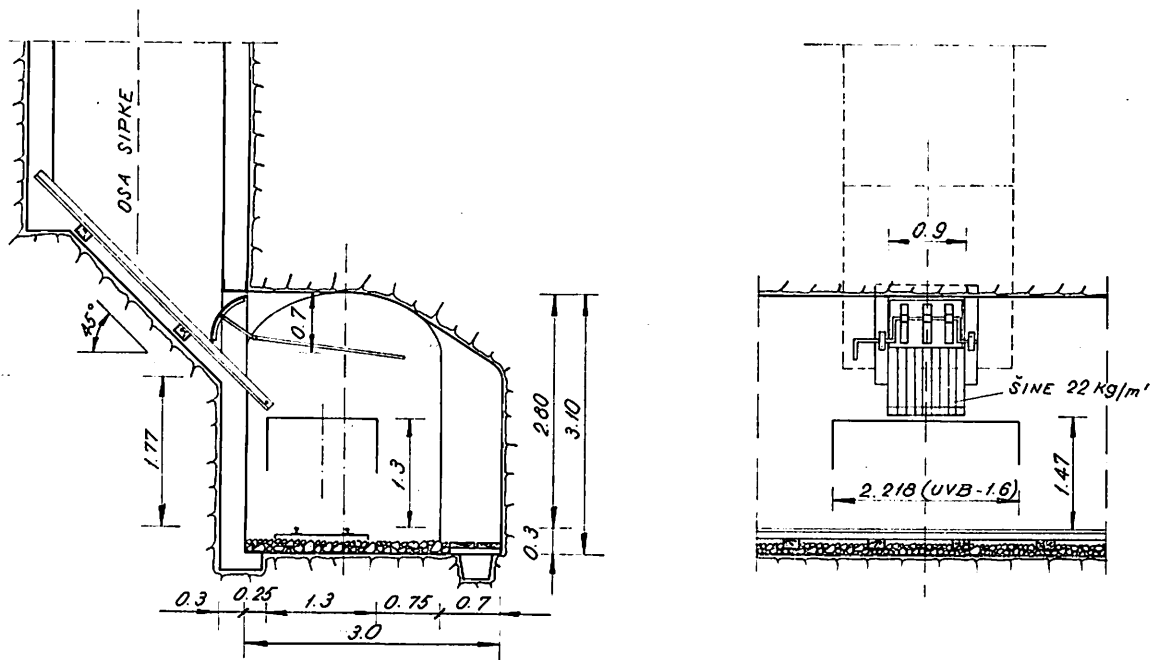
Типовая конструкция дна рудоспуска без устья выпускного отверстия
